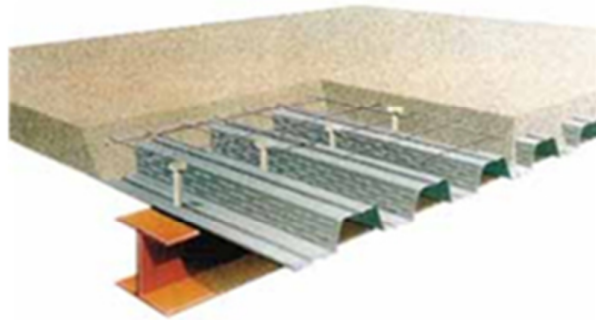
Esquema de uma laje steel deck com conectores de cisalhamento, apoiada sobre viga metálica (<http://www.arq.ufsc.br>, 2014)
